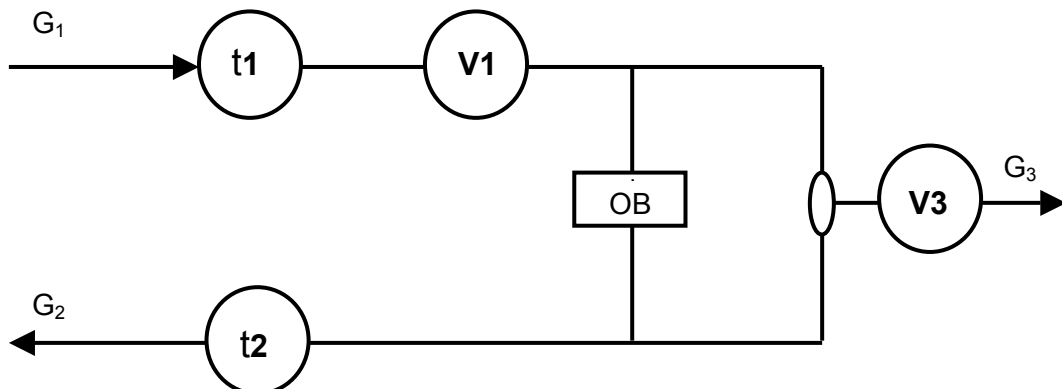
Открытая система теплоснабжения с водосчетчиком в подающем трубопроводе и трубопроводе ГВС.
